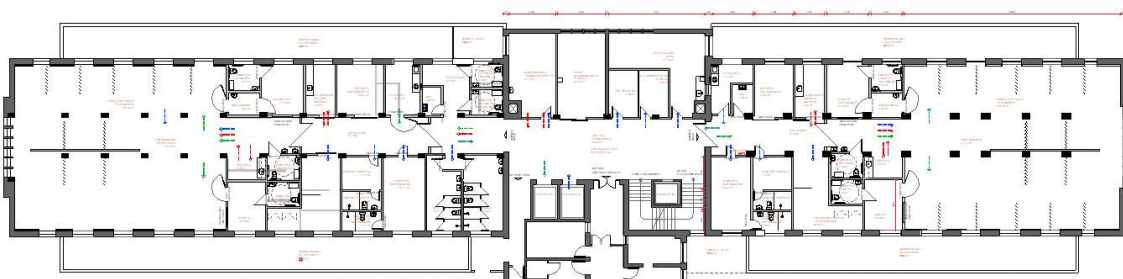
Recorte com a planta de fluxos. Folha 02 do Estudo Preliminar anexo.
